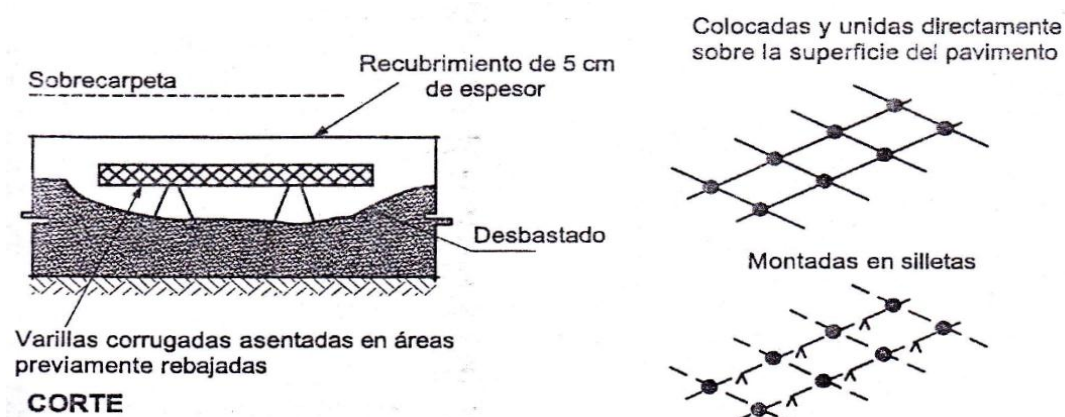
Detalle de un control de grietas aleatorias
